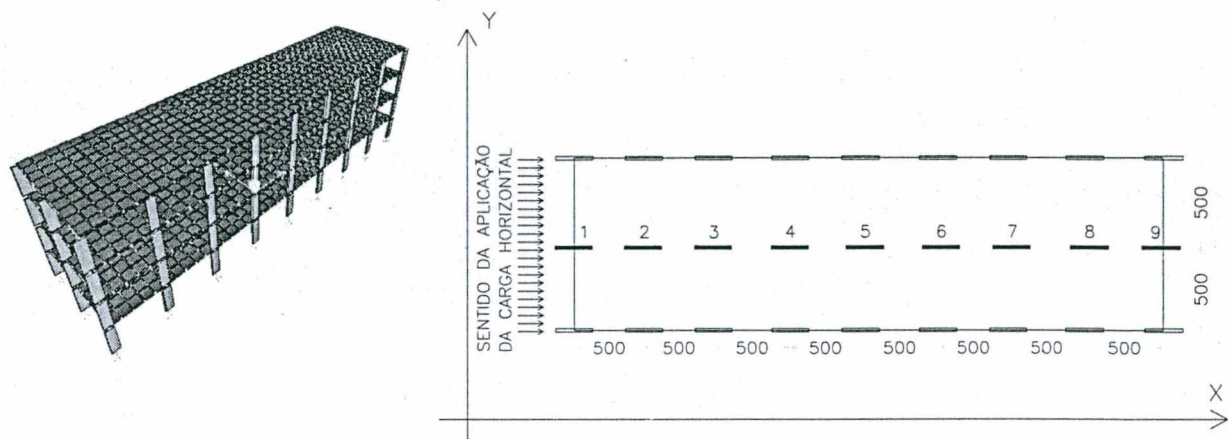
Perspectiva e planta baixa do edifício 10x40m com 4 pavimentos
